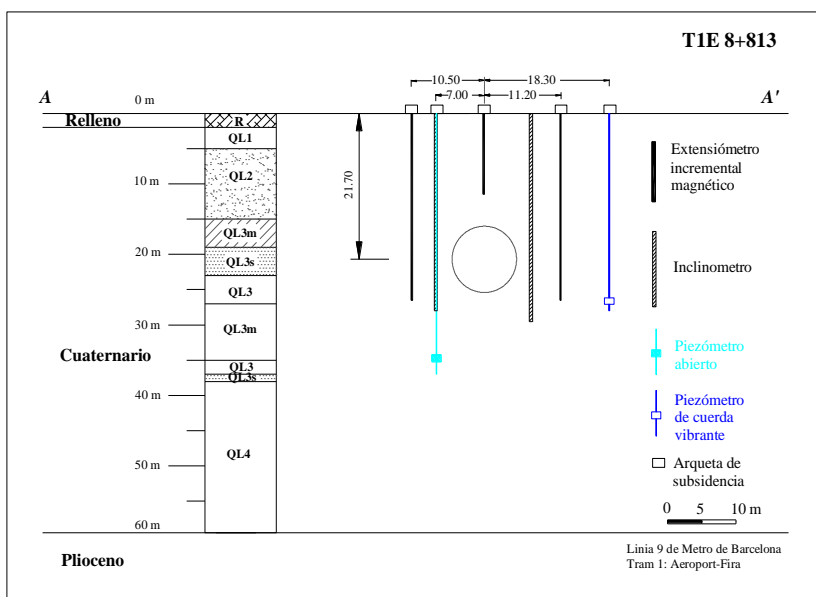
44. Perfil de la instrumentación instalada en la sección de control TIE PK 8+813
